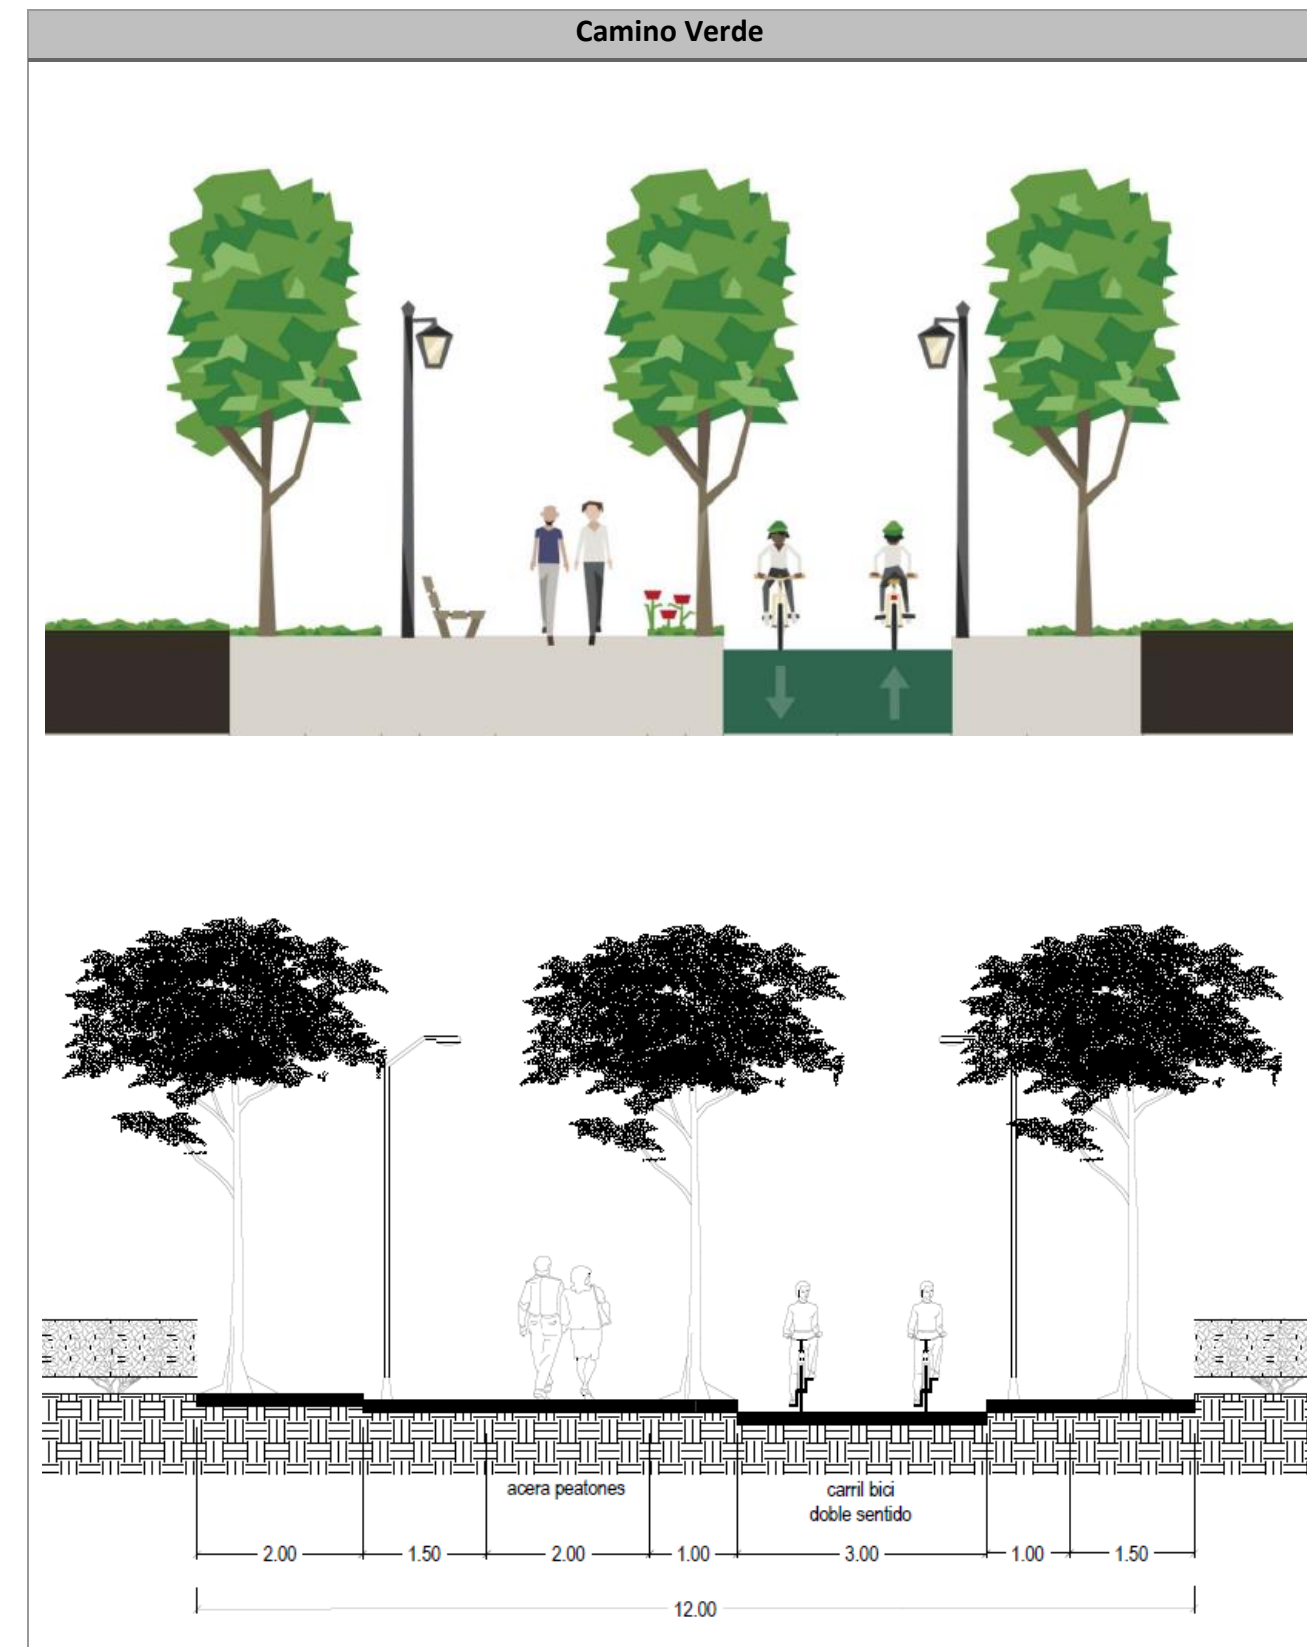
Sección transversal tipo para Camino Verde. Fuente: Elaboración propia.
